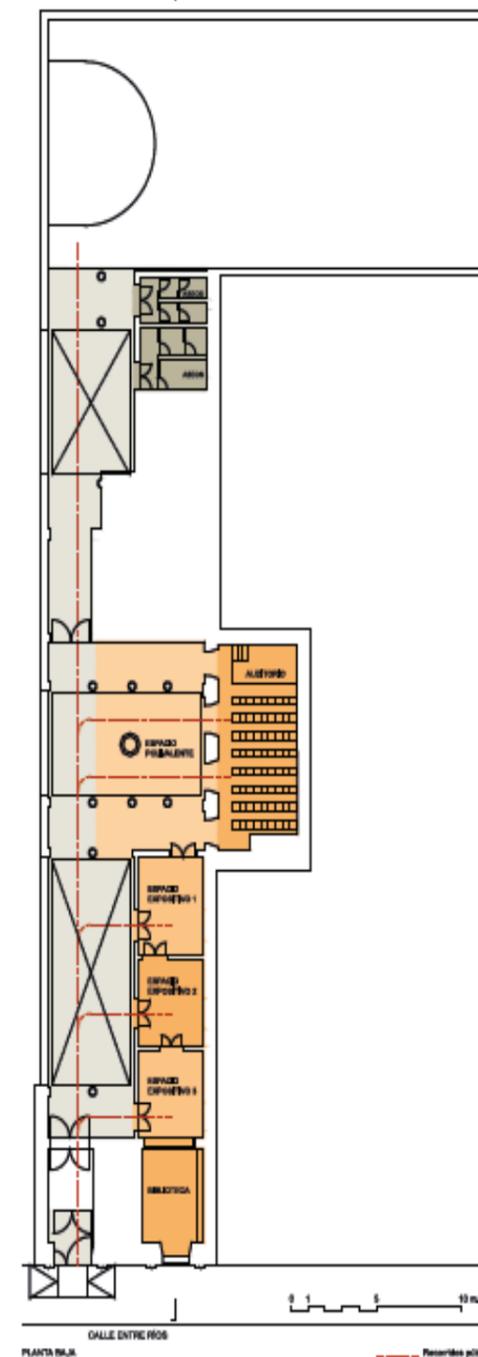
Planta arquitectónica Casa Garzón Maceda
